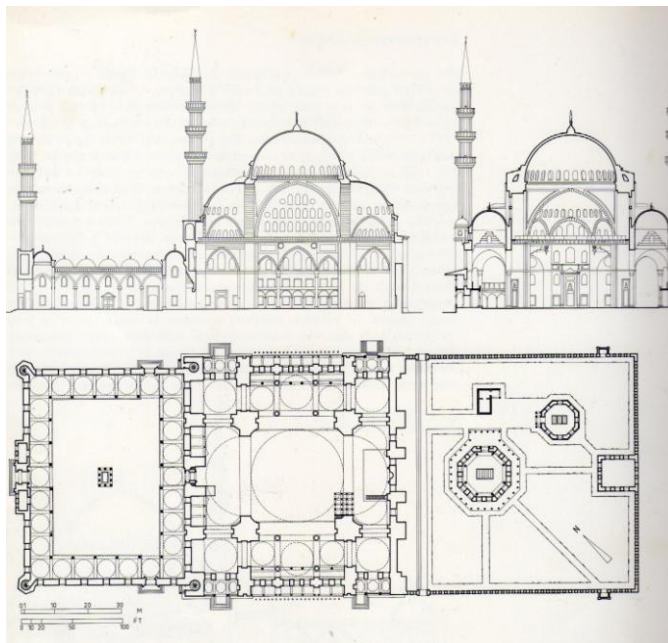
Coupe et plan de la Soulaymaniye, Source (Stierlin, 1979, p 218)
